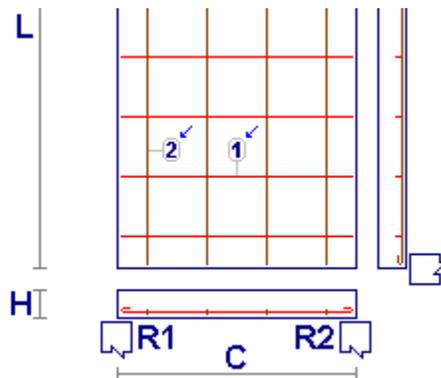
Vista parcial de la Losa, señalando identificadores de varillas de acero.
